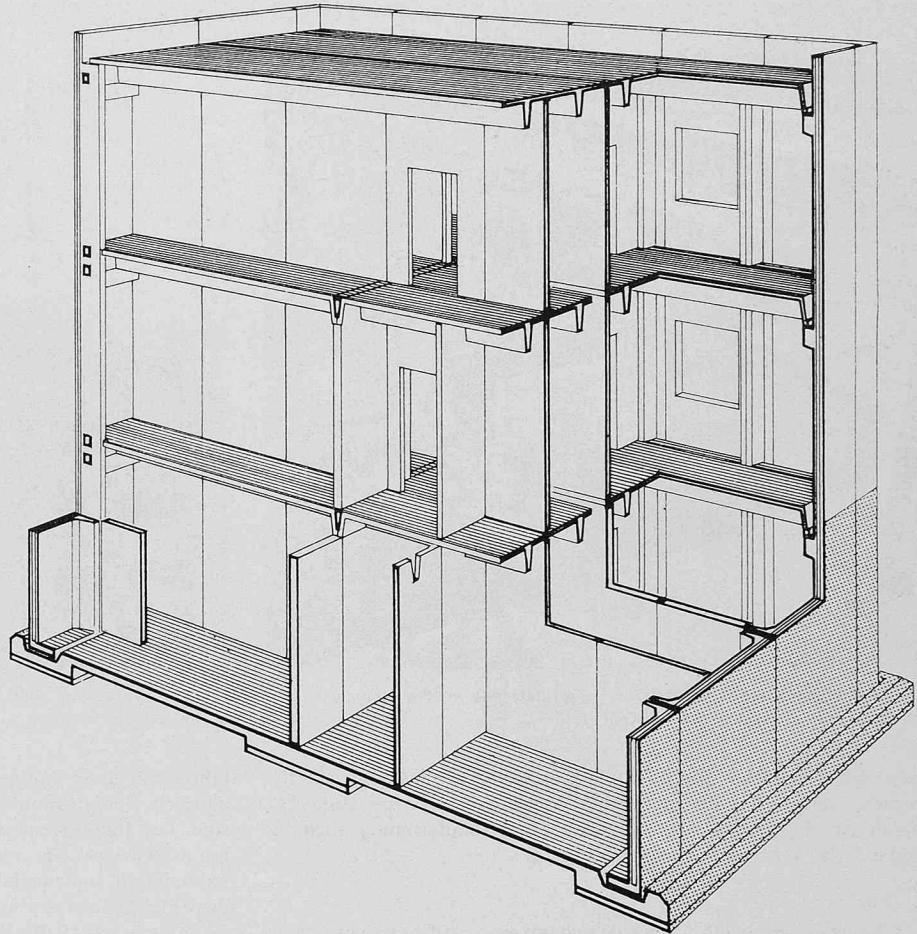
(rechts). Normengebäude für Ortsvermittlungsstellen mit Wahlbetrieb der Deutschen Bundespost, Konstruktionslösung ausschliesslich mit Flächentragwerken
